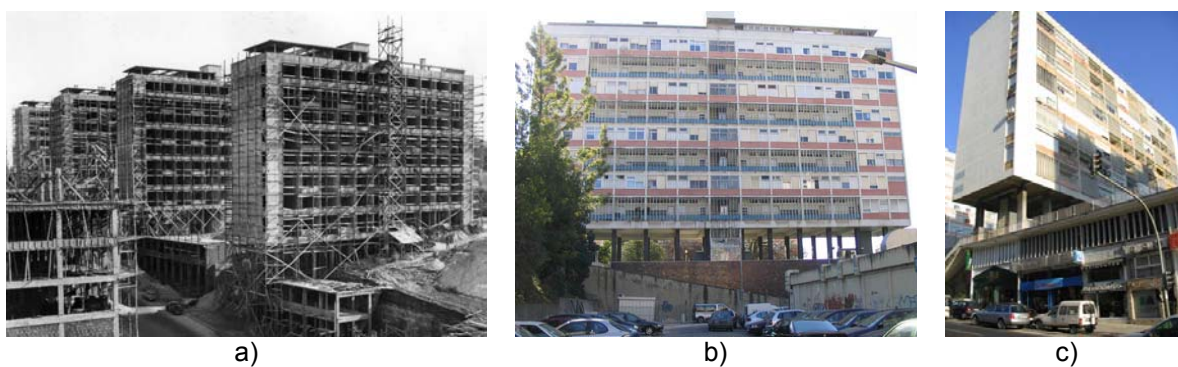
Fotos do edifício: a) Construção b) Fachada c) perspectiva
